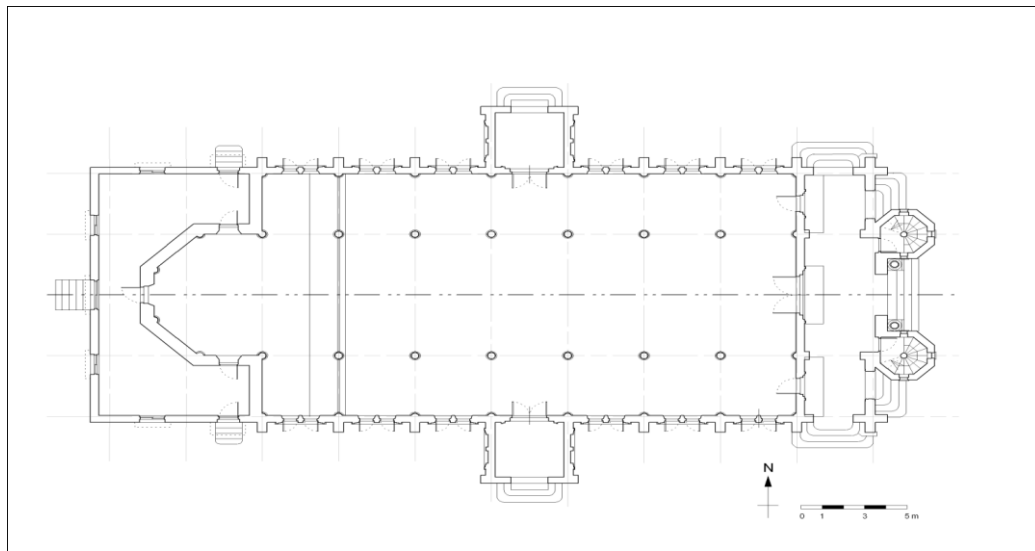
今村天主堂 平面図 (羽深研究室 製図)
